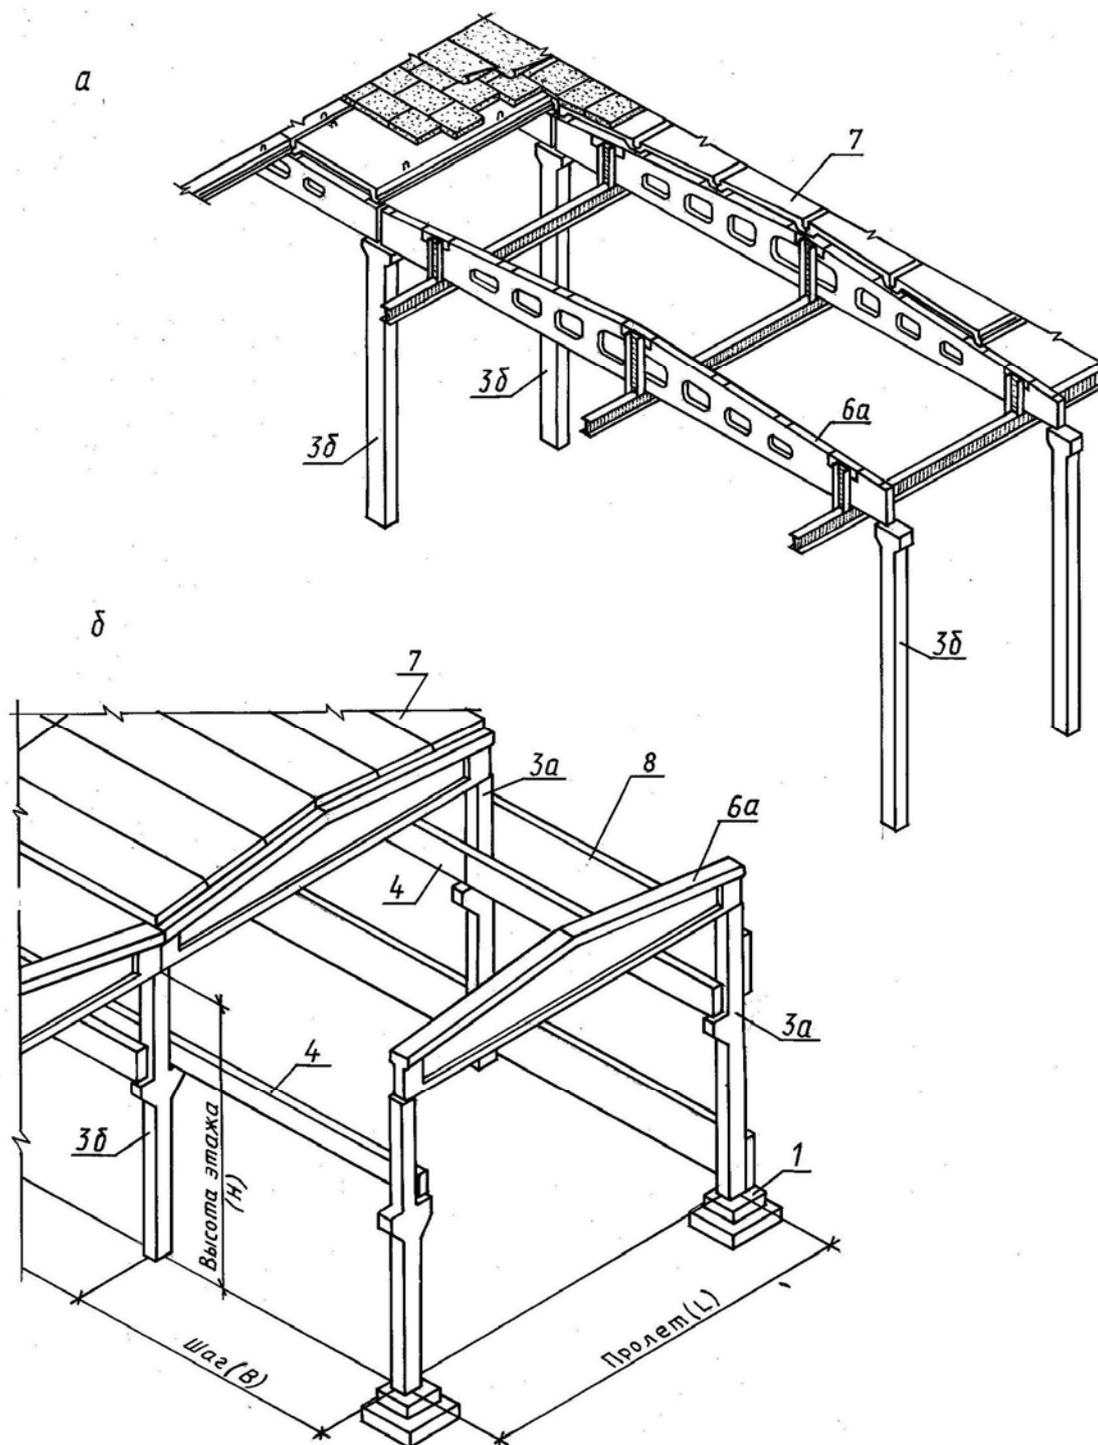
Фрагменты каркасов одноэтажных зданий без подстропильных конструкций:
